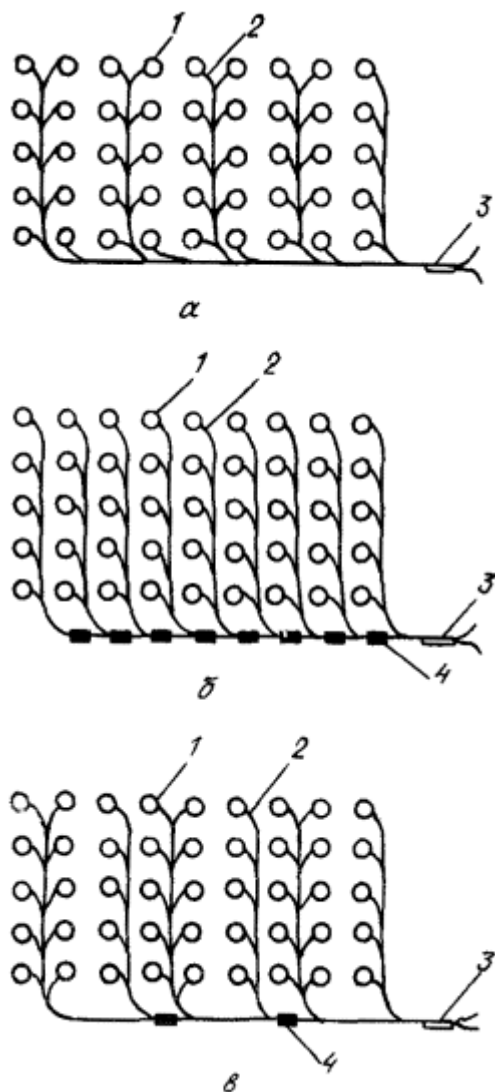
Схемы монтажа взрывной сети при взрывании фундаментов:
